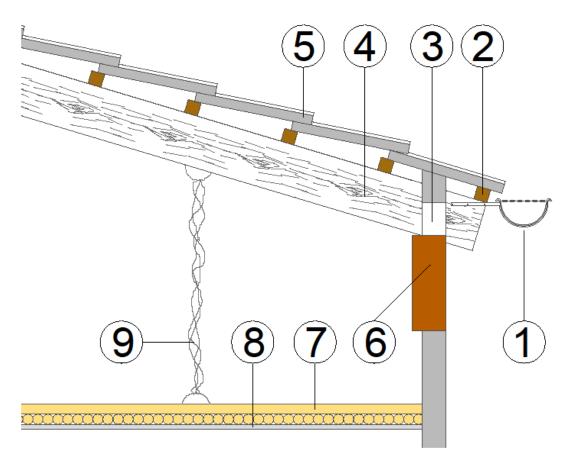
Detalle de cubierta en extremo canalón. Elaboración propia
